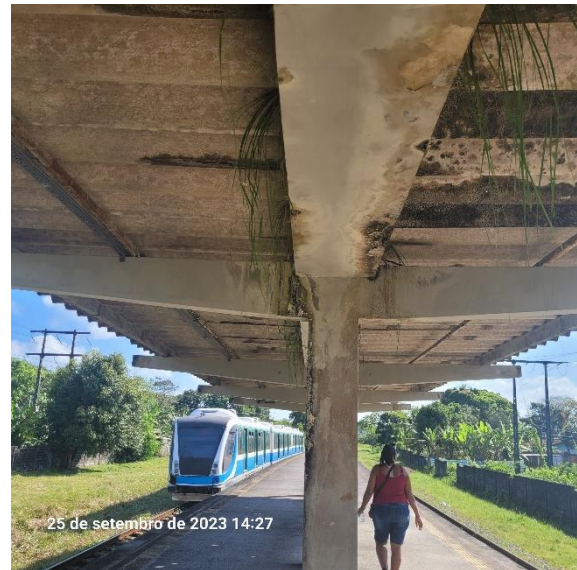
Telhas danificadas e infiltrações nas vigas e colunas
